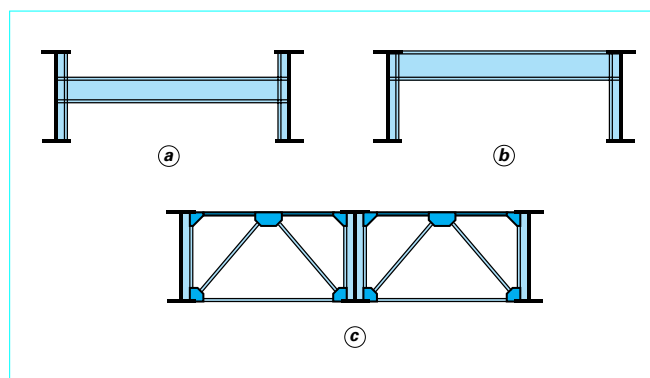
Entretoisements souples et entretoisement rigide (multipoutre à entretoise triangulée)
